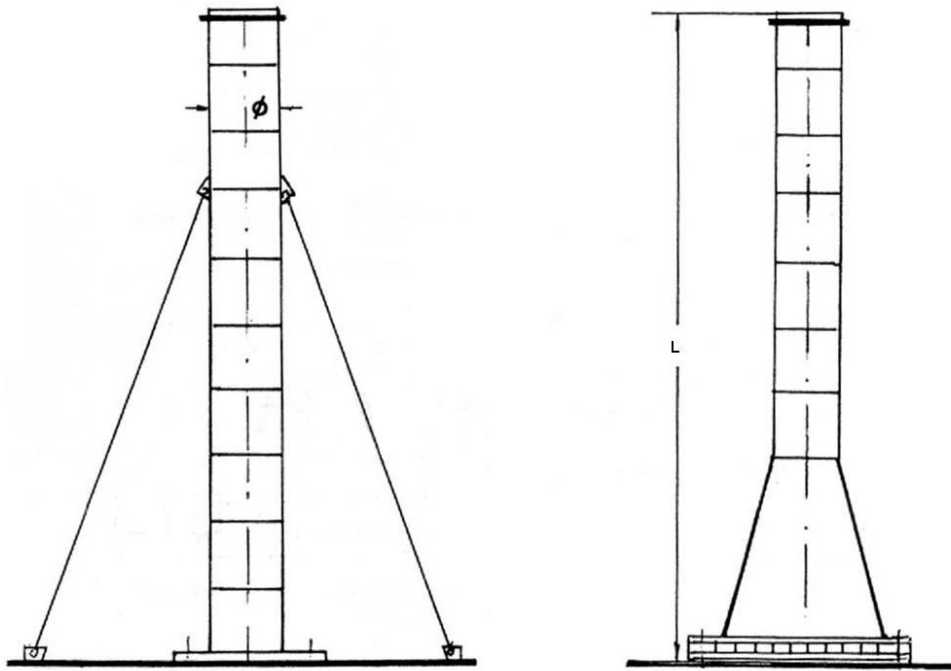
Tipos construtivos de chaminé: (E) Atirantada e (D) Auto estável
